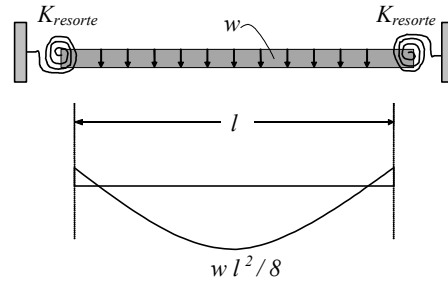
Modelo simplificado fuera del plano para el muro en contacto
